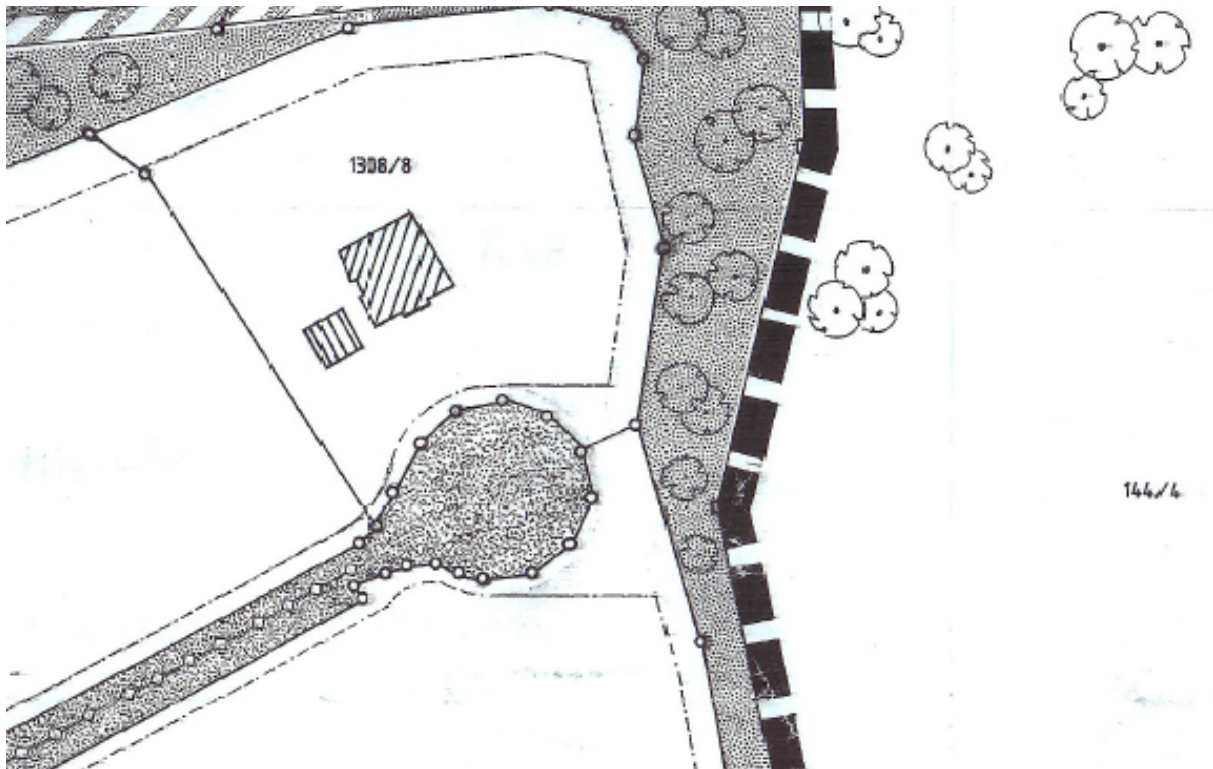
Auszug aus dem Bebauungsplan „Im Wolfsgraben“ der Gemeinde Unterbreizbach (ohne Maßstab)
